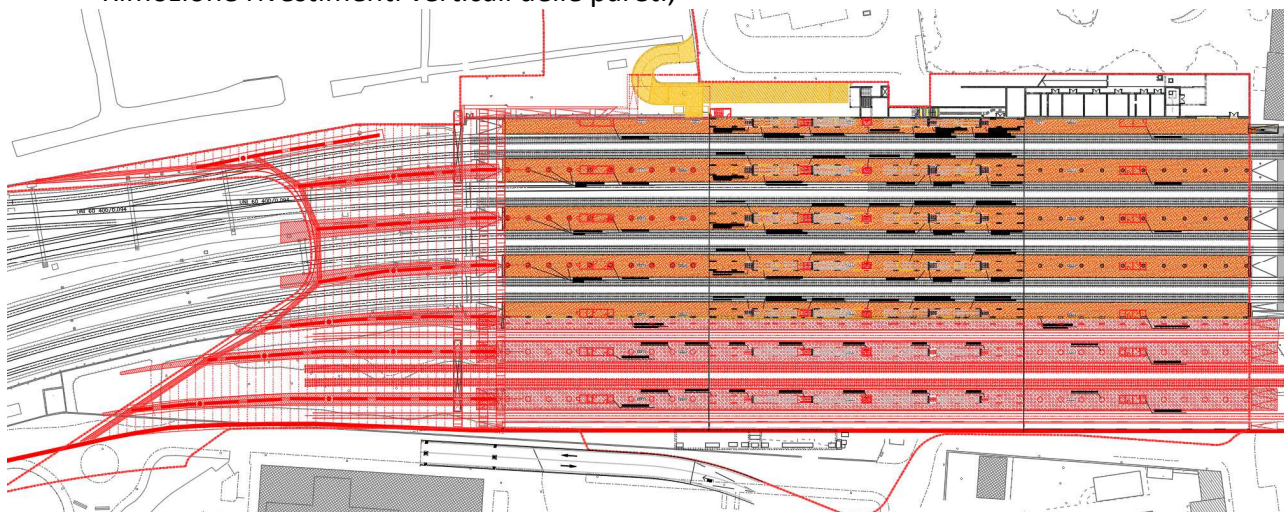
Planimetria demolizioni Piano Banchine Stazione di Bovisa (demolizioni in giallo)
